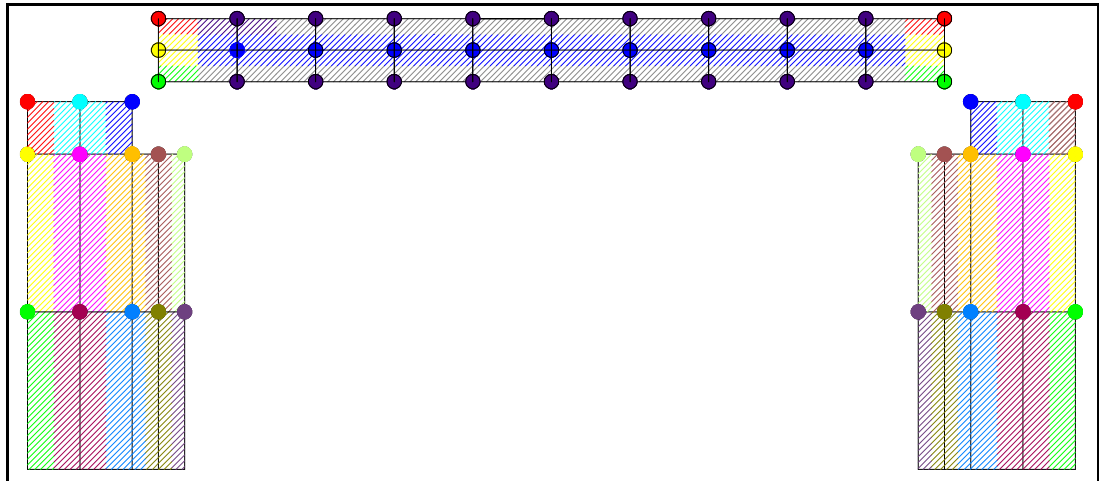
Geometría de los estribos y de la viga longitudinal del Puente
